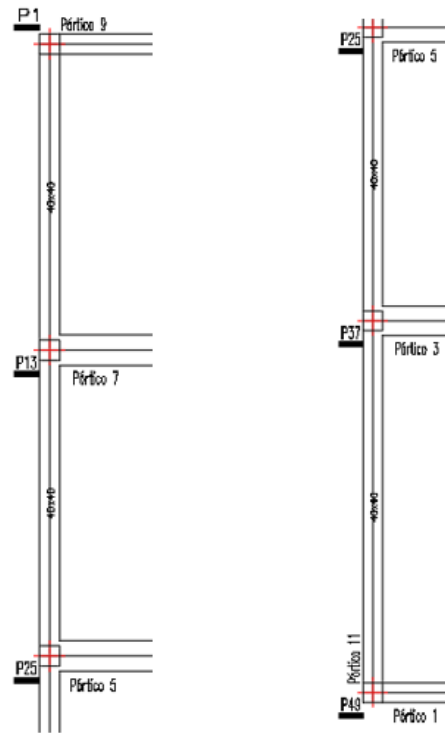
Pormenor do Pórtico 11 (segmentado) – Pilar P49 a P1.
